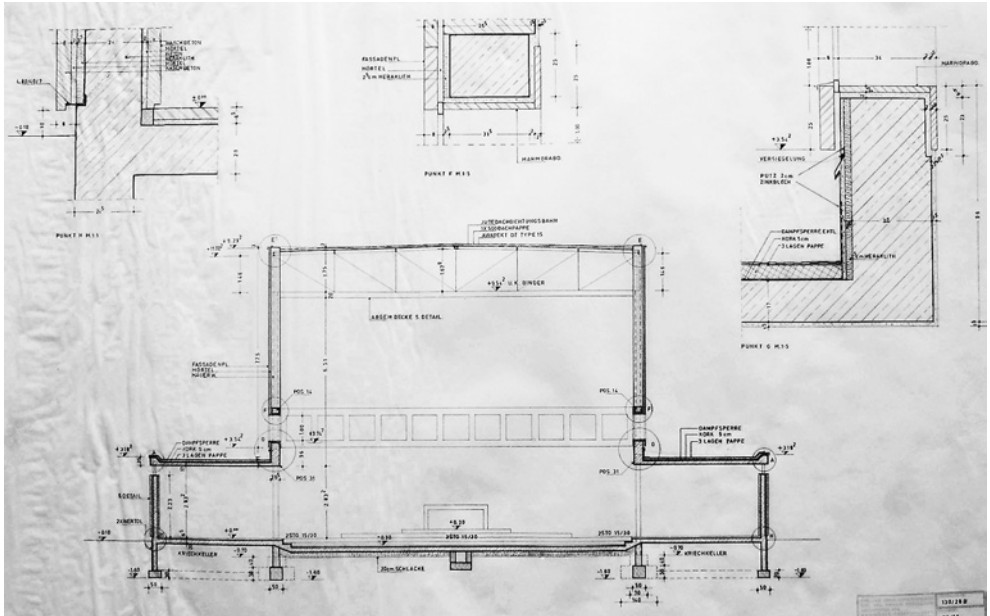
Querschnitt der Kirche mit Details zum Wand- u. Dachaufbau;
